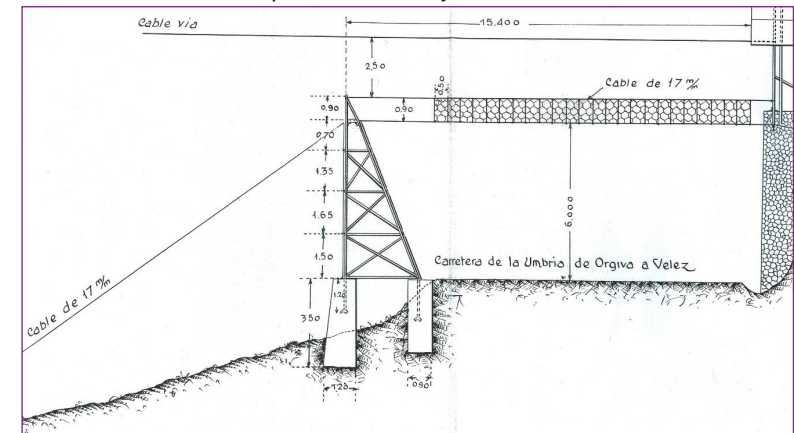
Detalle de sección en cruzamiento de la línea con un vial. Fuente: proyecto constructivo.
